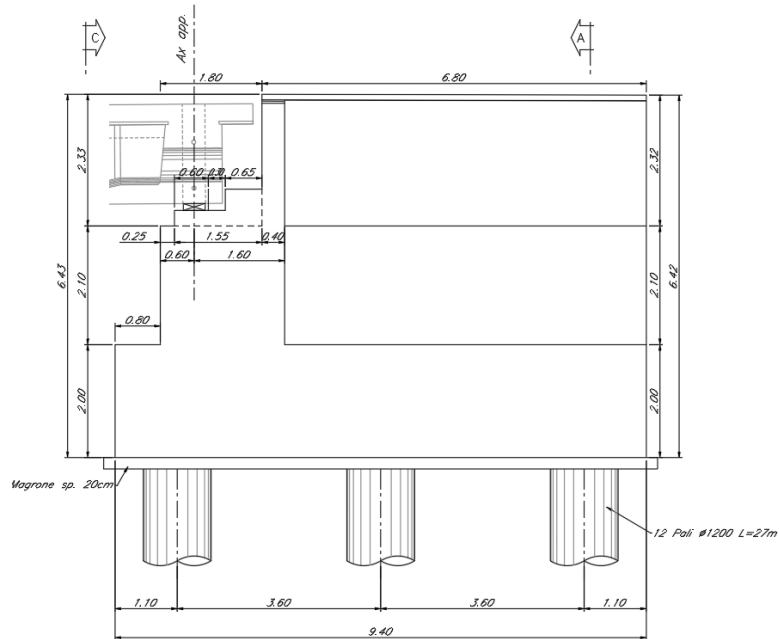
Spalla A – Sezione trasversale
